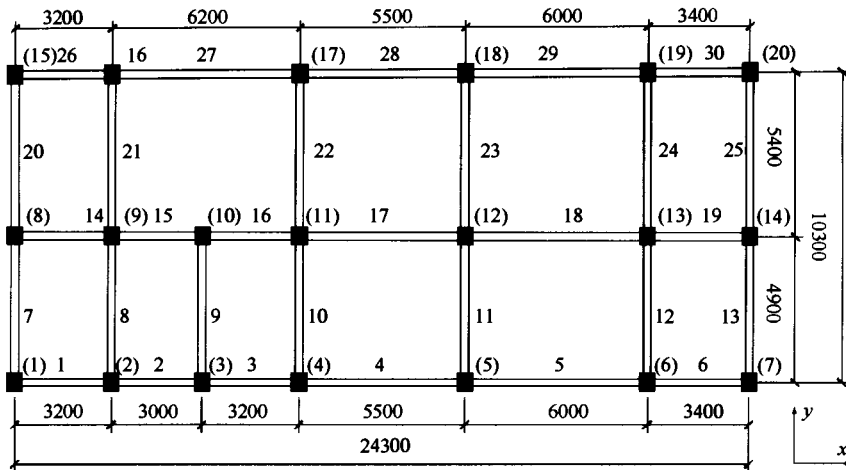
隔（抗）震房屋标准层平面图（单位：mm）
